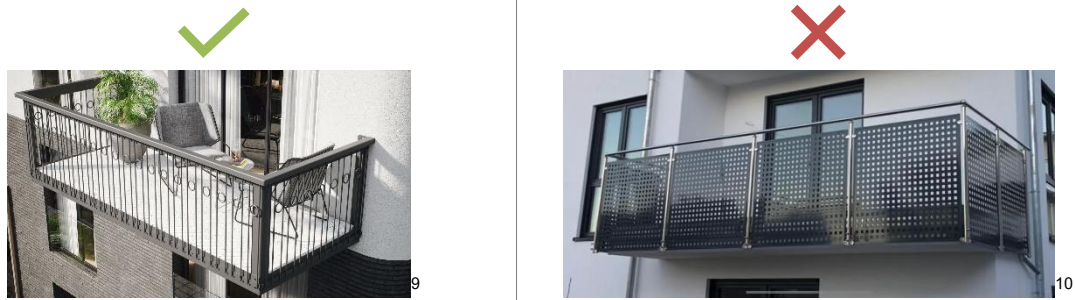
Erklärende Beispiele zur Ausführung der Balkonbrüstungen
